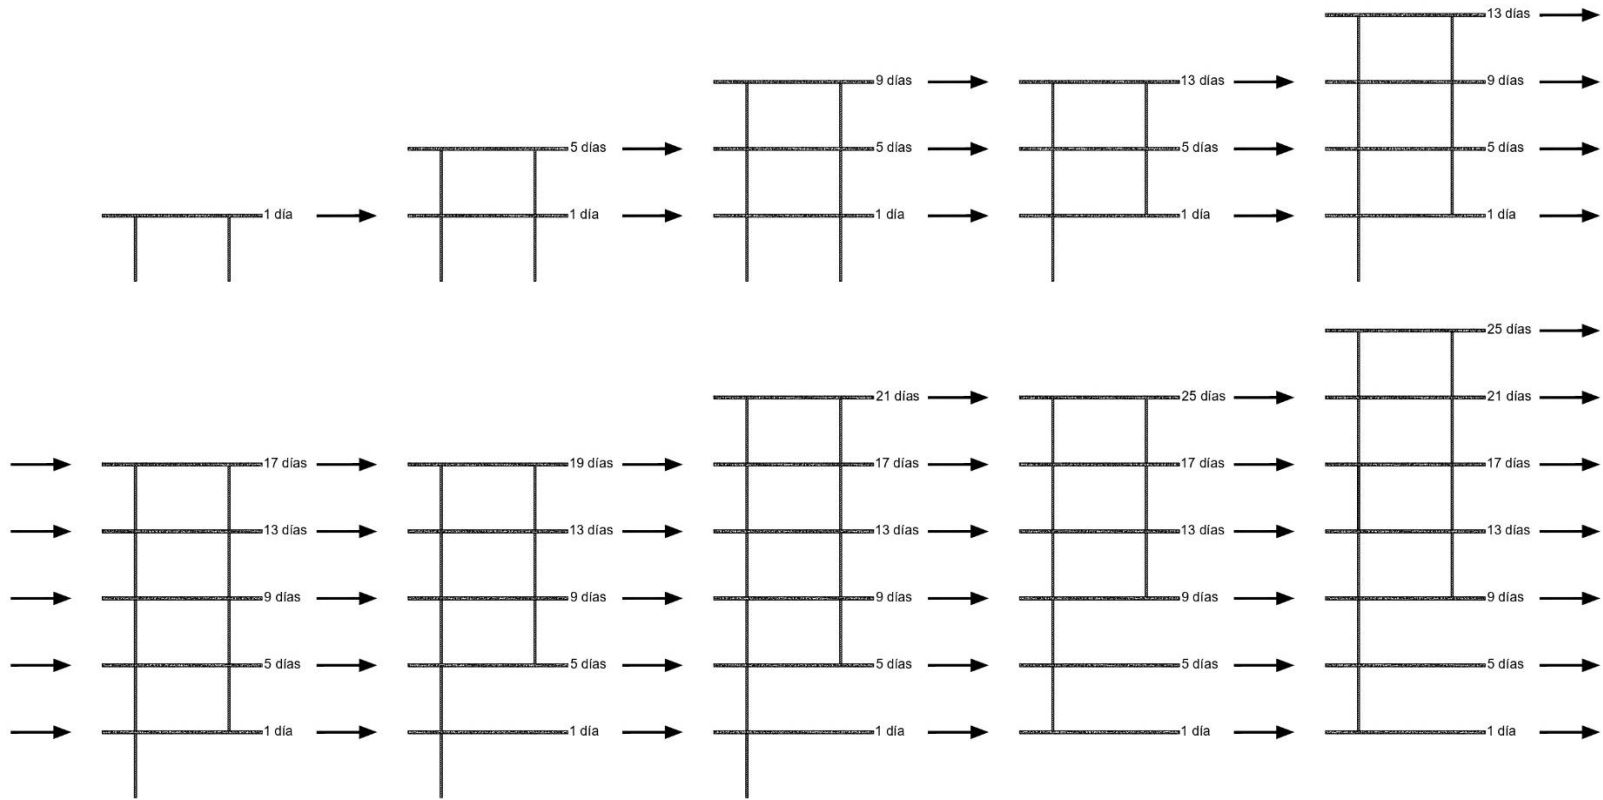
Secuencia de apuntalamiento y desapuntalamiento para una losa de una planta de entrepiso colada en cuatro secciones
